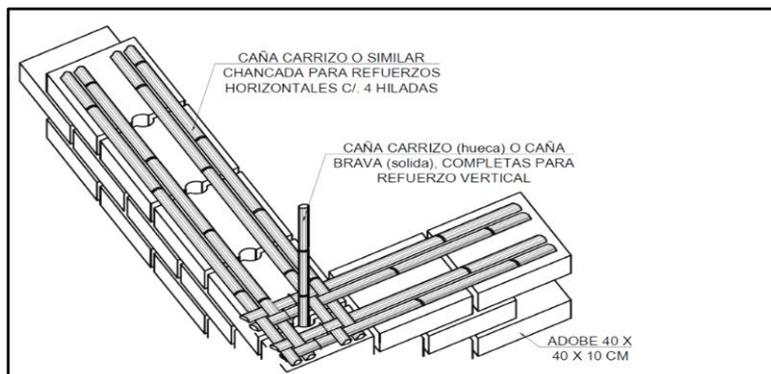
Amarre de encuentros de muros de adobe con refuerzo de caña
